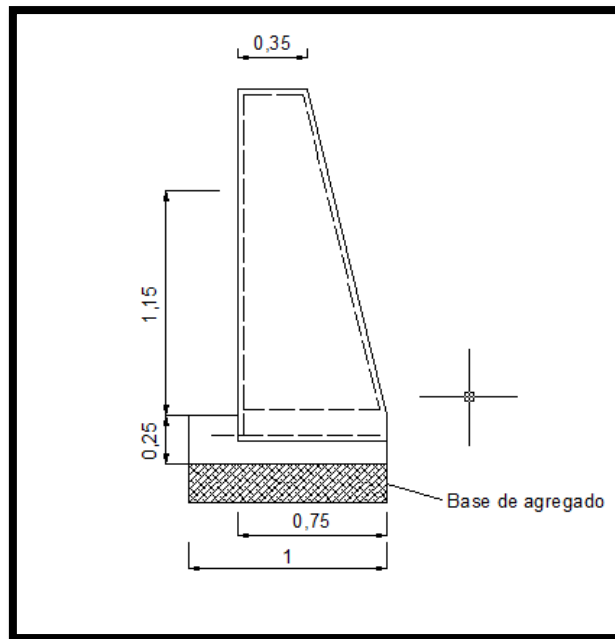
Vista lateral de cabezal para alcantarillas de 1200mm.
